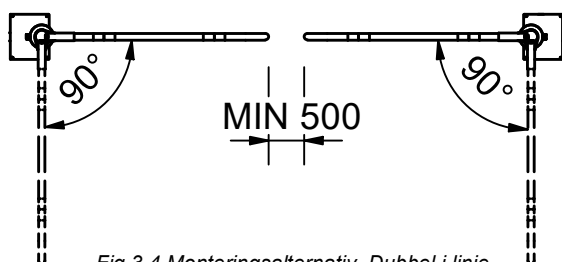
Monteringsalternativ, Dubbel i linje Medurs- & Motorshängd.
